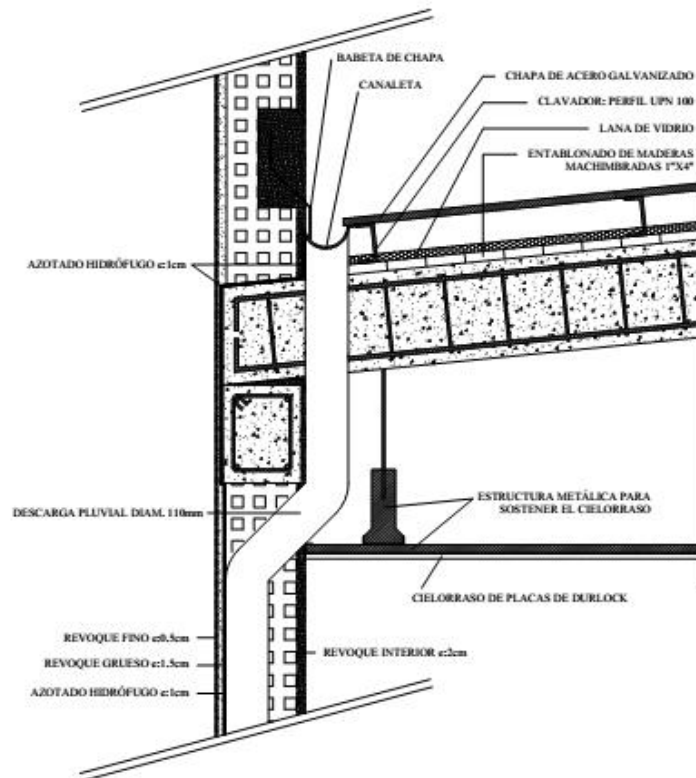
Encuentro de cubierta con muro exterior y desagüe pluvial
